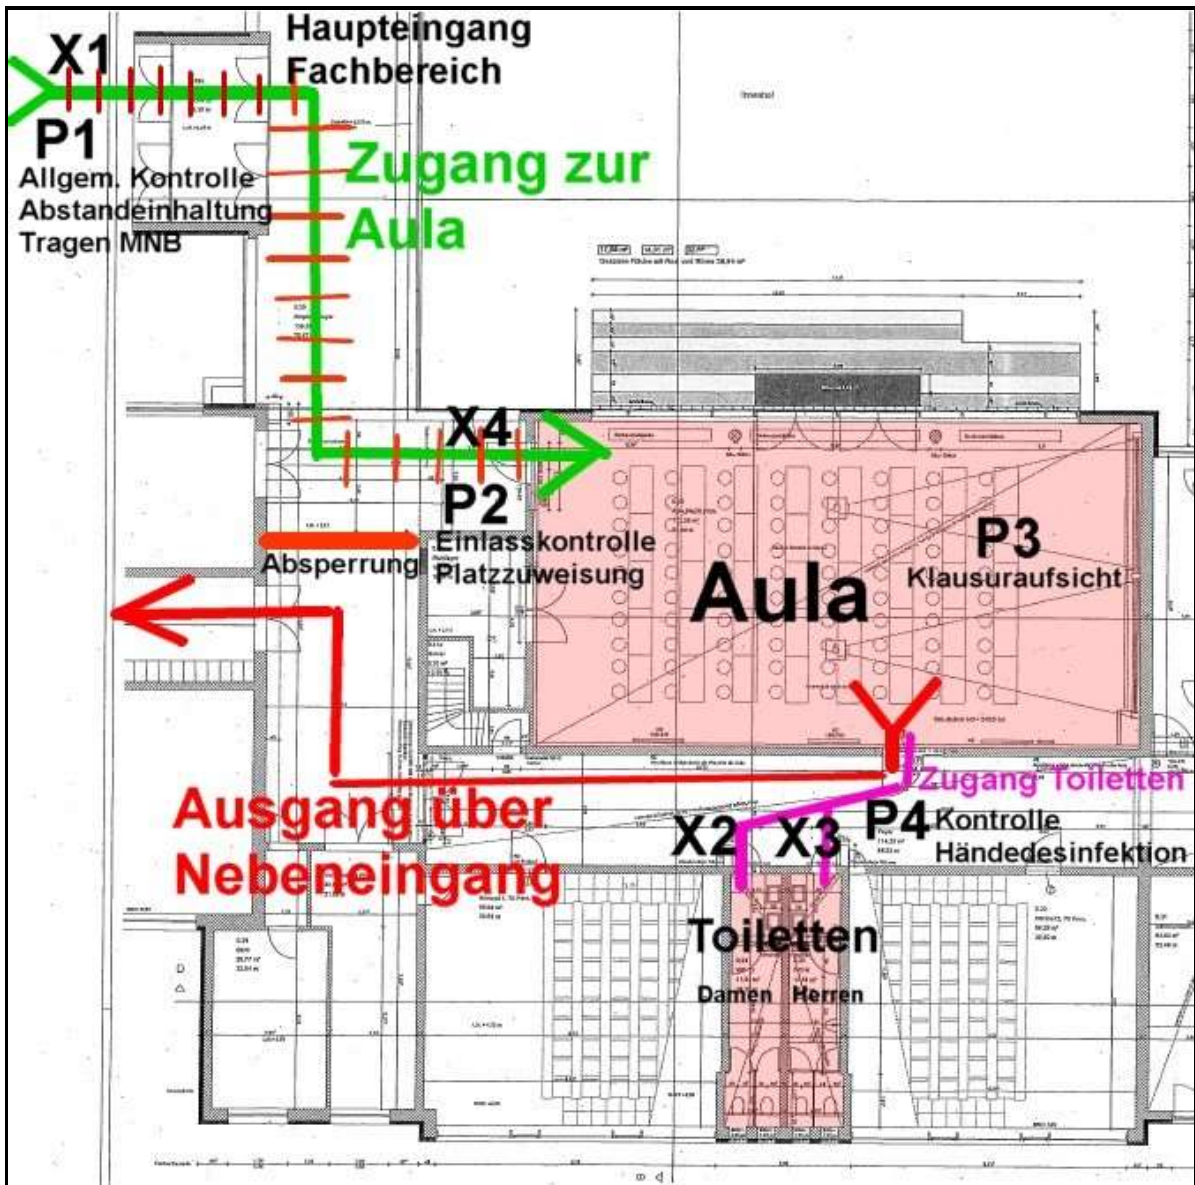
Lageplan des Prüfungssaales „Aula“ im Hauptgebäude des Fachbereiches
